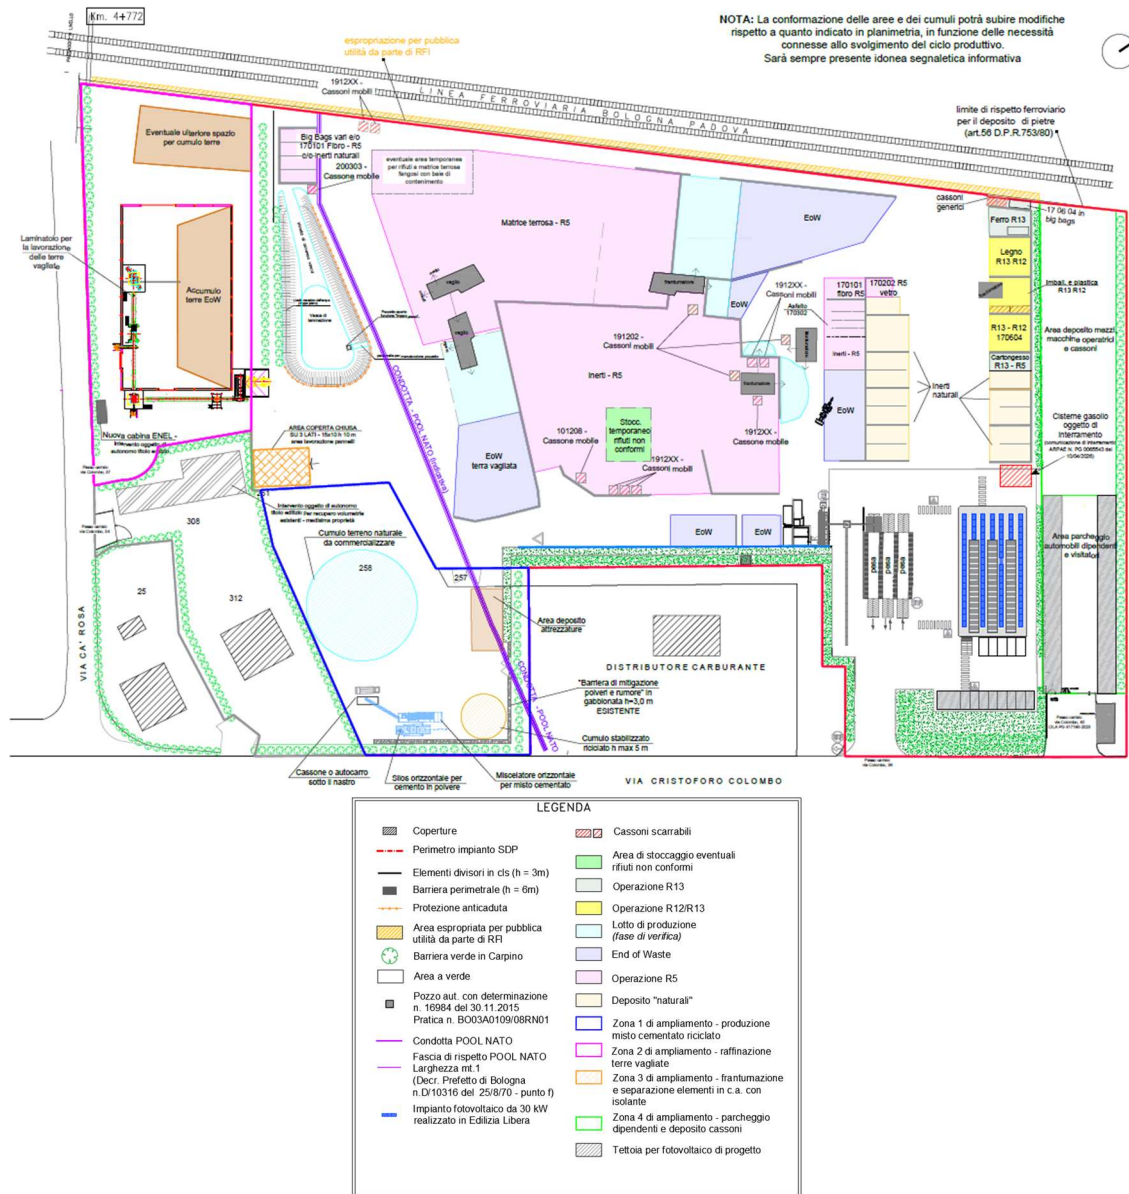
Configurazione impianto di progetto (stralcio Tav. 3)
